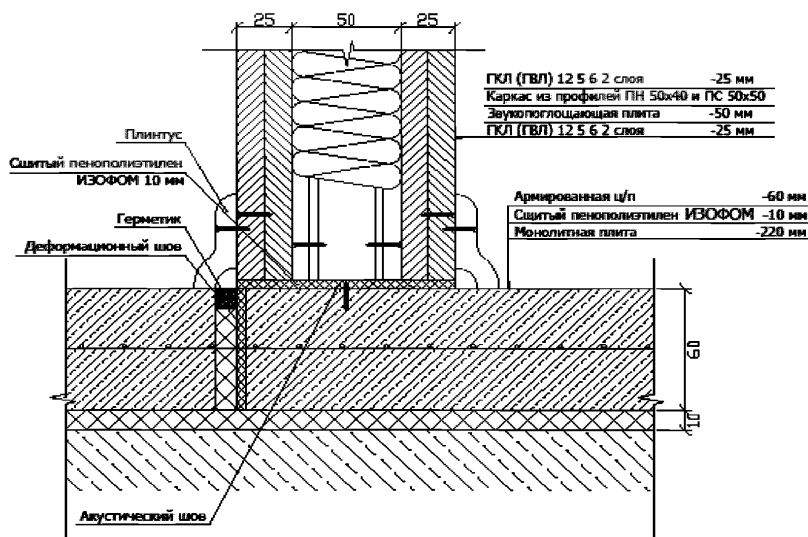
Узел примыкания звукоизоляционной облицовки к конструкции плавающего пола
